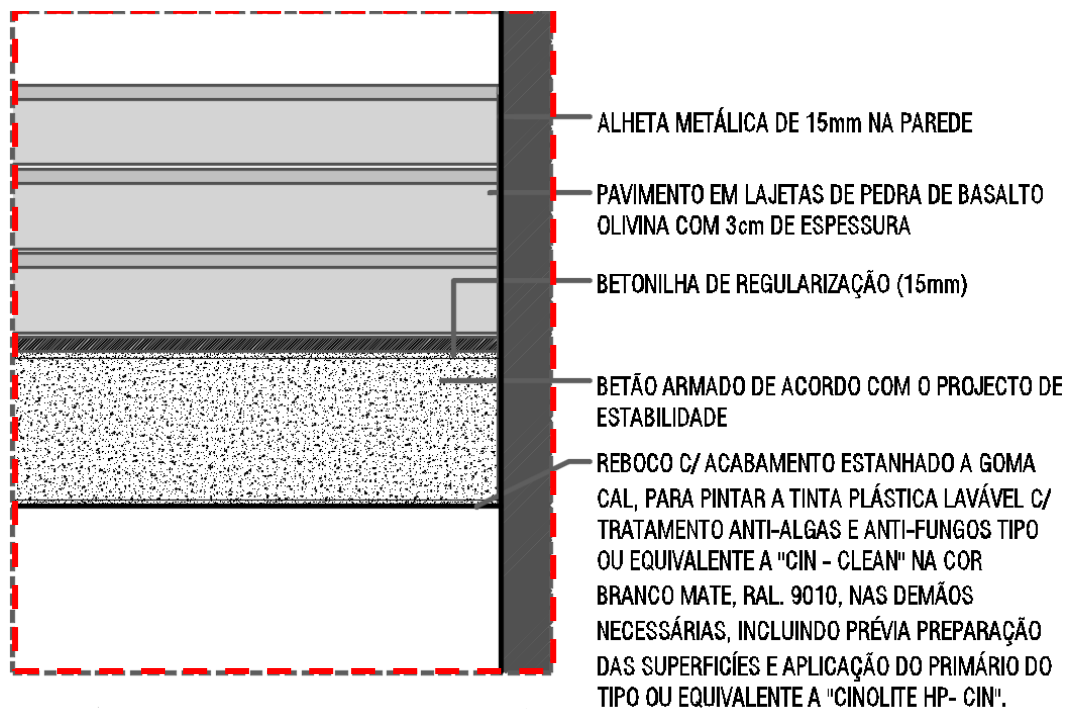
Pormenor construtivo e legenda da escada de acesso ao piso 01 e 02
